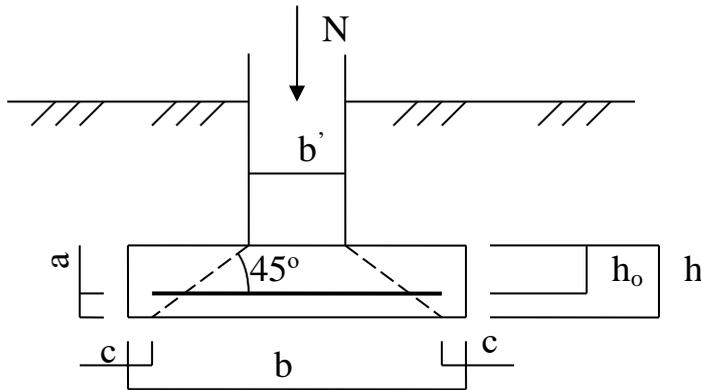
Схема до розрахунку конструкції центрально навантаженого фундаменту
